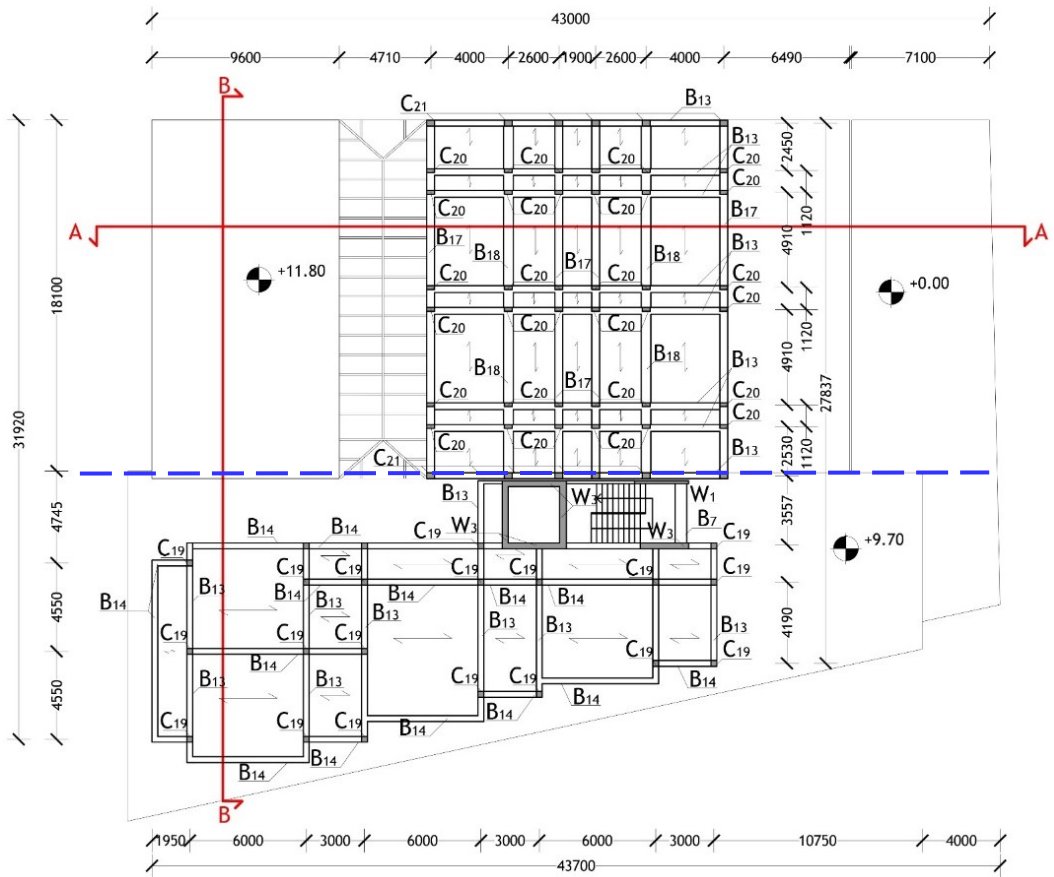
Pianta strutturale dal secondo al quinto piano dell'albergo (a partire dalla quota +14,50 m a +24,55 m)
